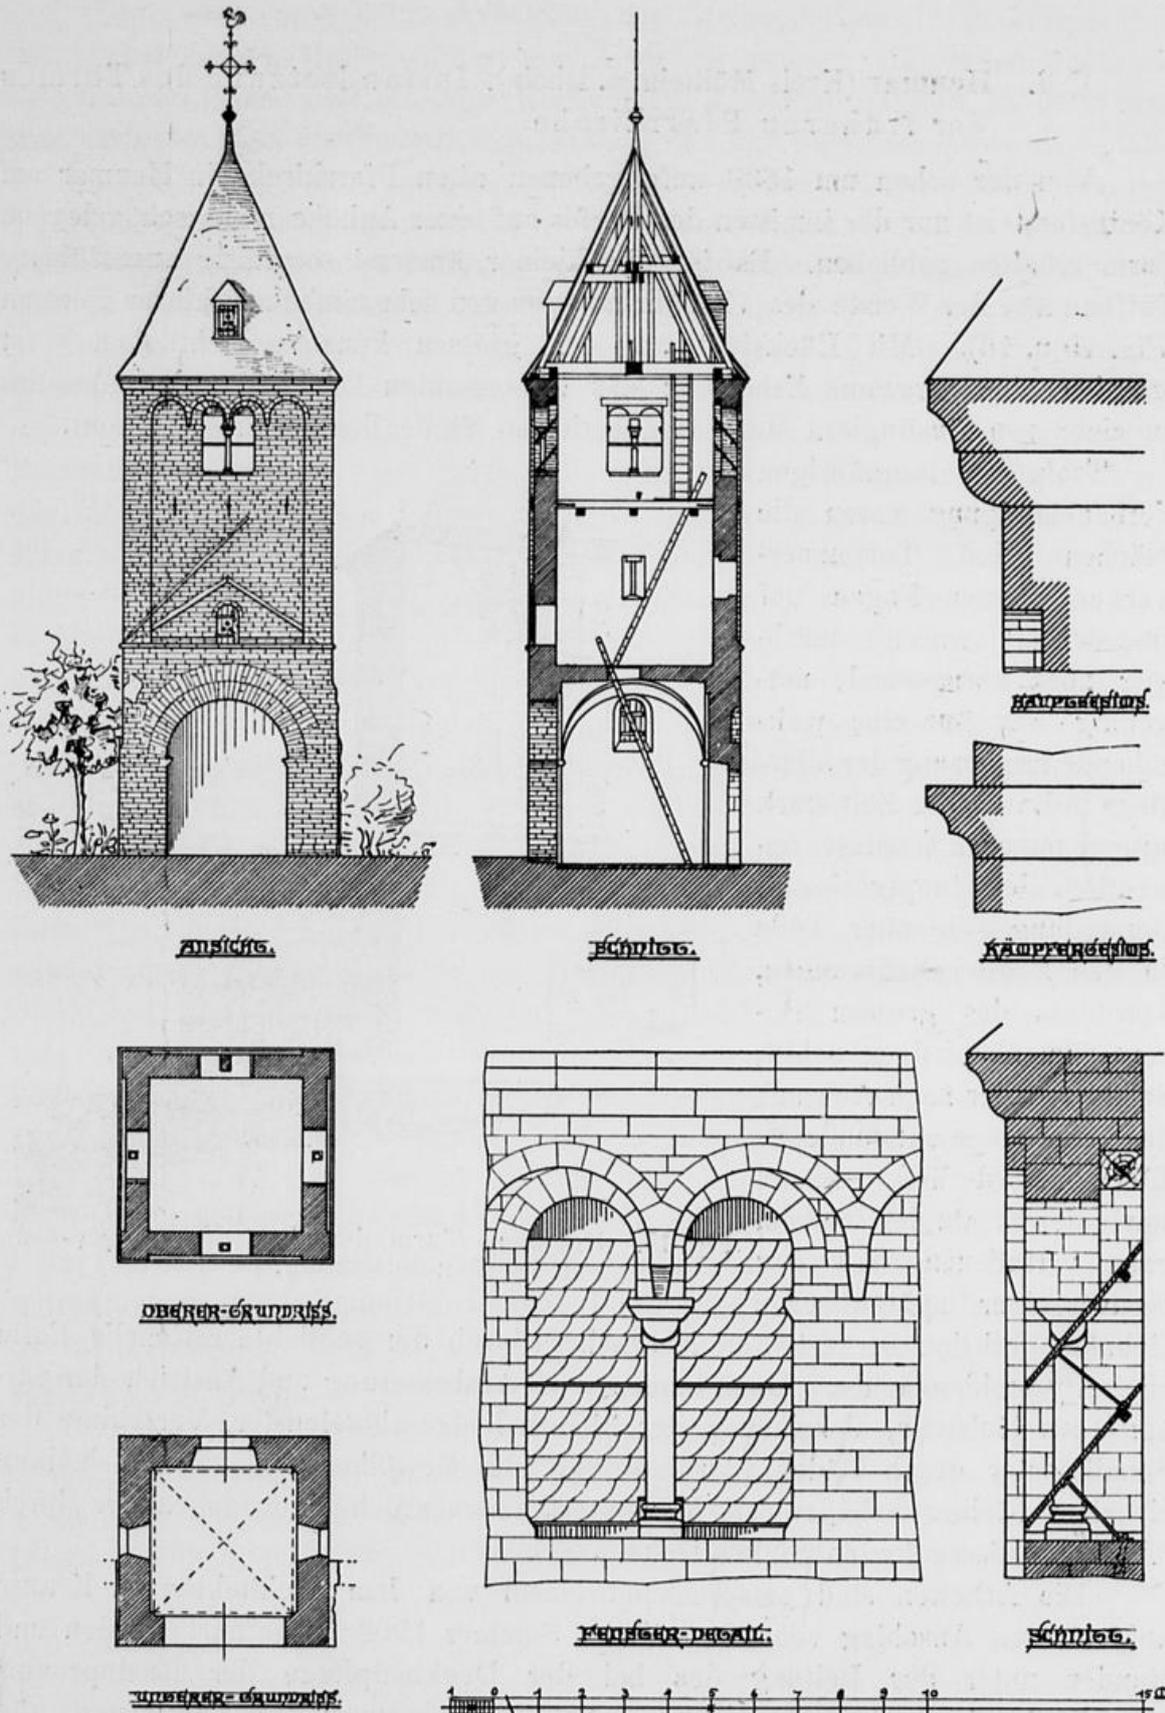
Heumar. Aufriss, Schnitt, Grundrisse und Details des Turmes der alten Kirche nach der Instandsetzung.
